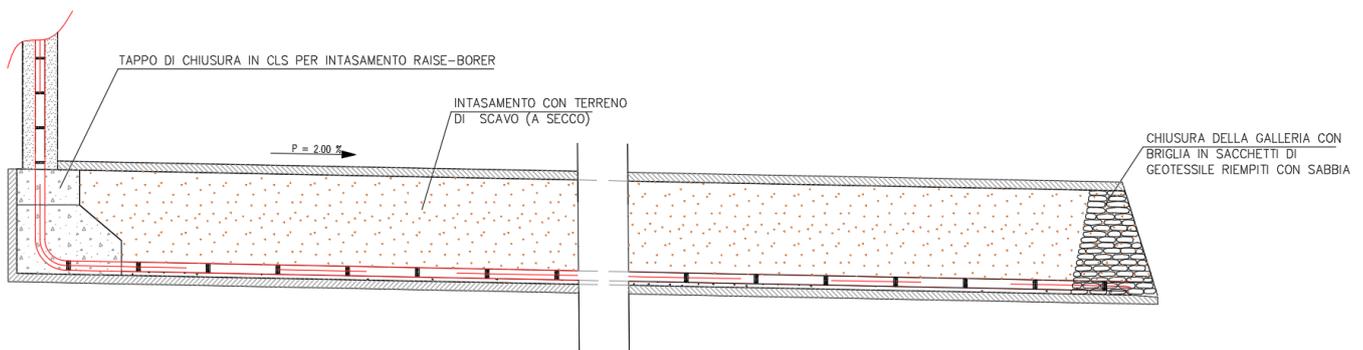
/B – Profilo galleria Orizzontale con L= 200m
